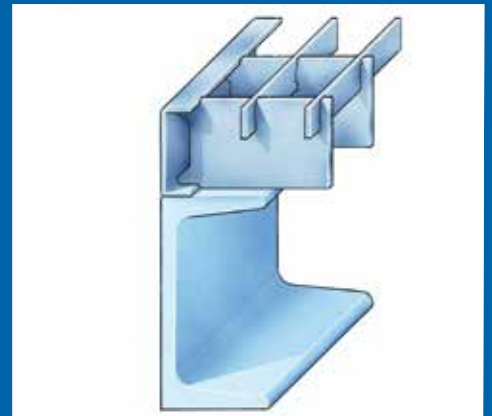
Darstellung einer Gitterrostauflage im eingebauten Zustand.
